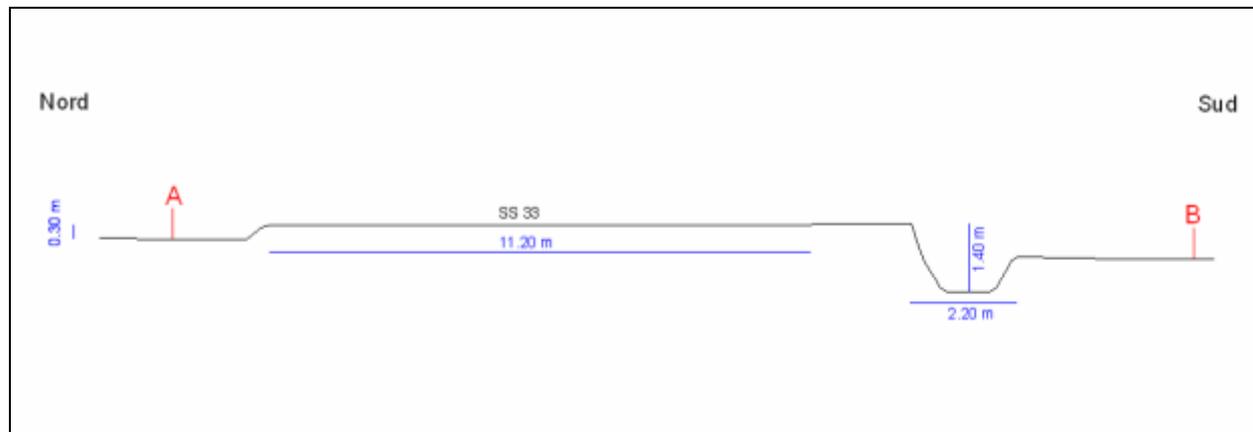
Sezione schematica del tratto stradale di interesse (SS33)
